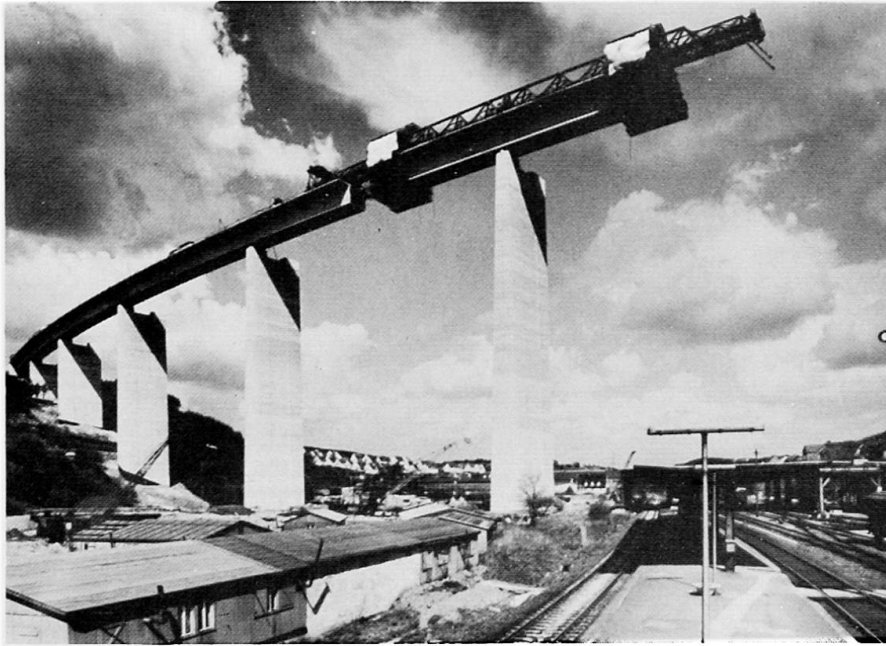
Siegtal-Brücke Eiserfeld. 8)
